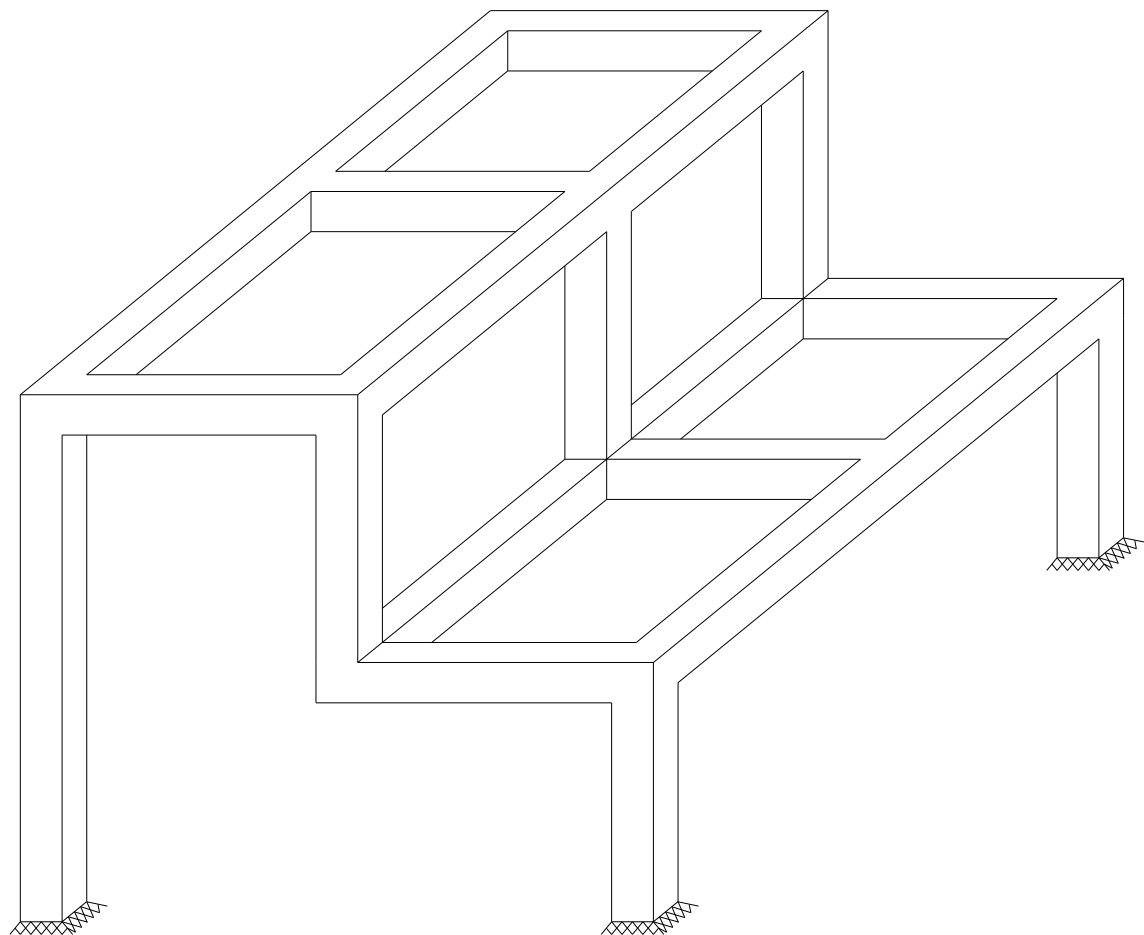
a Sistem Struktur Balok Menerus
